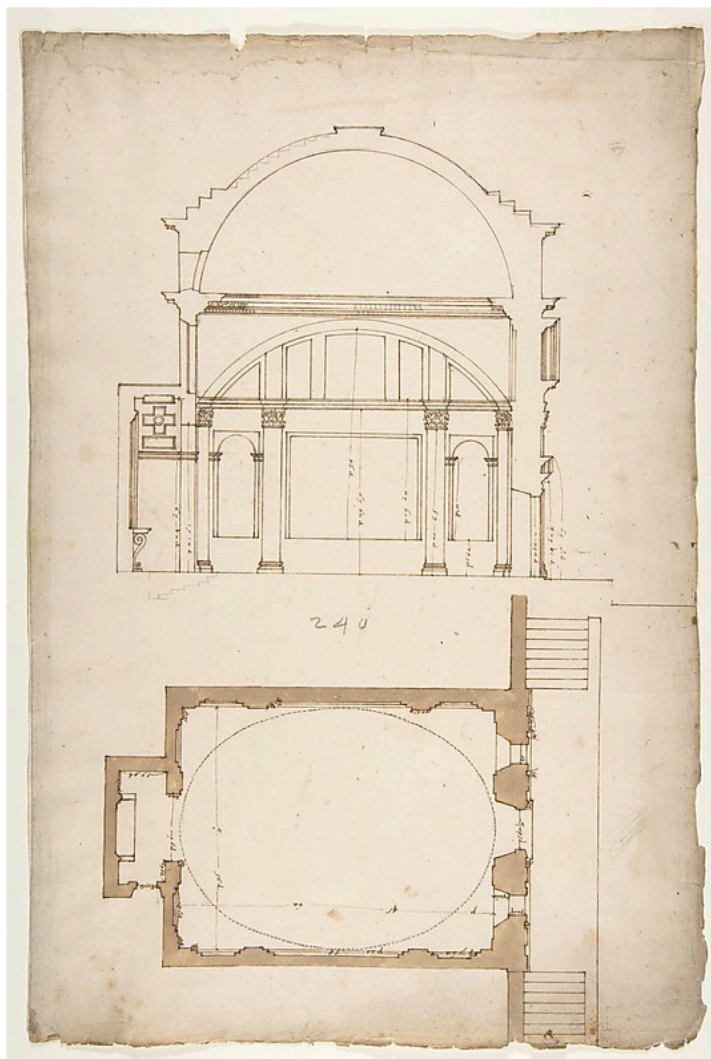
San Andrea in Via Flaminia. Planta y alzado.
